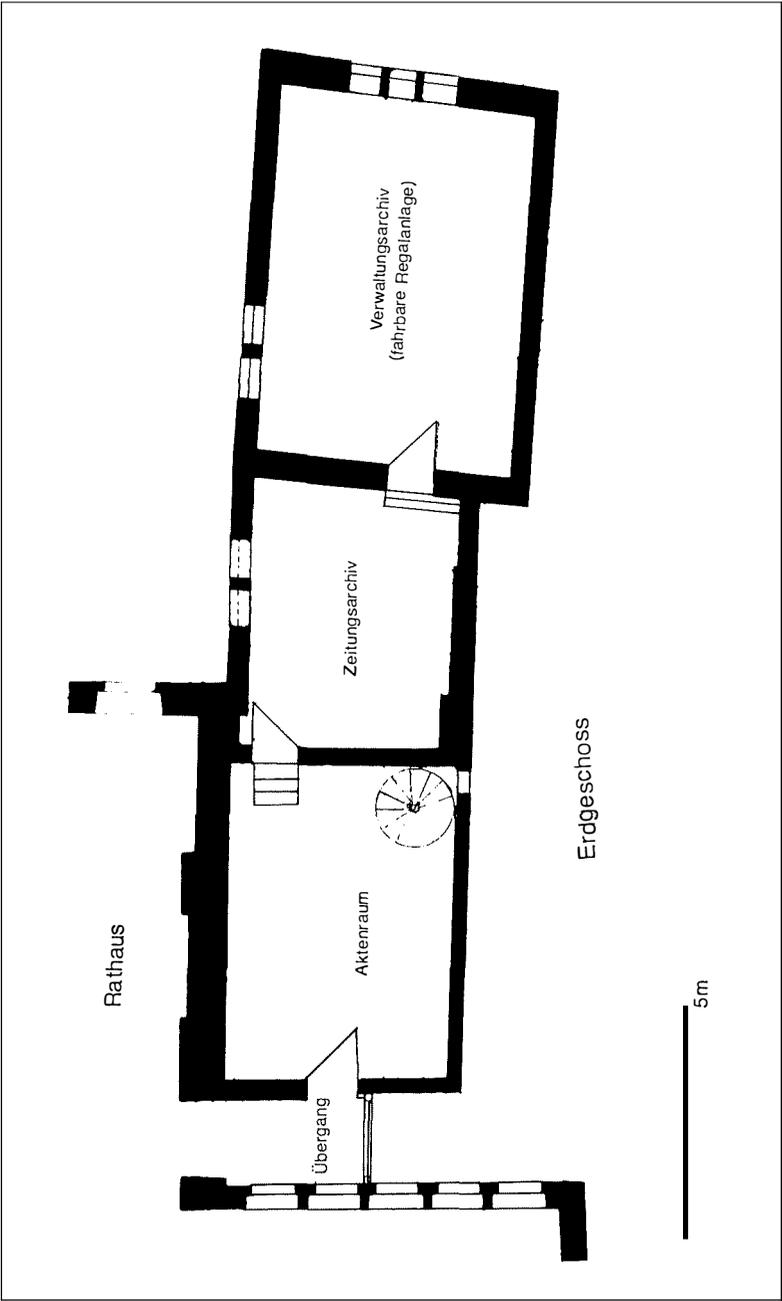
Stadtarchiv Goch, Anbau an das Rathaus. Erdgeschoss-Grundriß.
